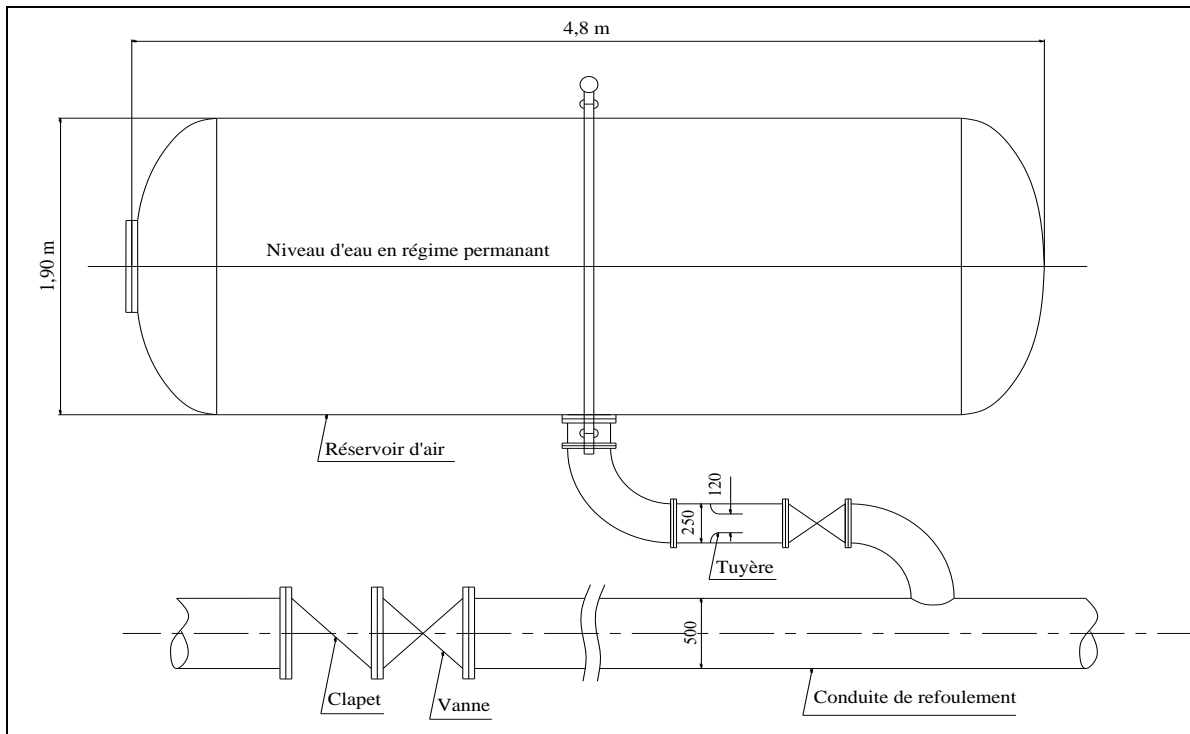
Schéma d'installation du réservoir d'air
